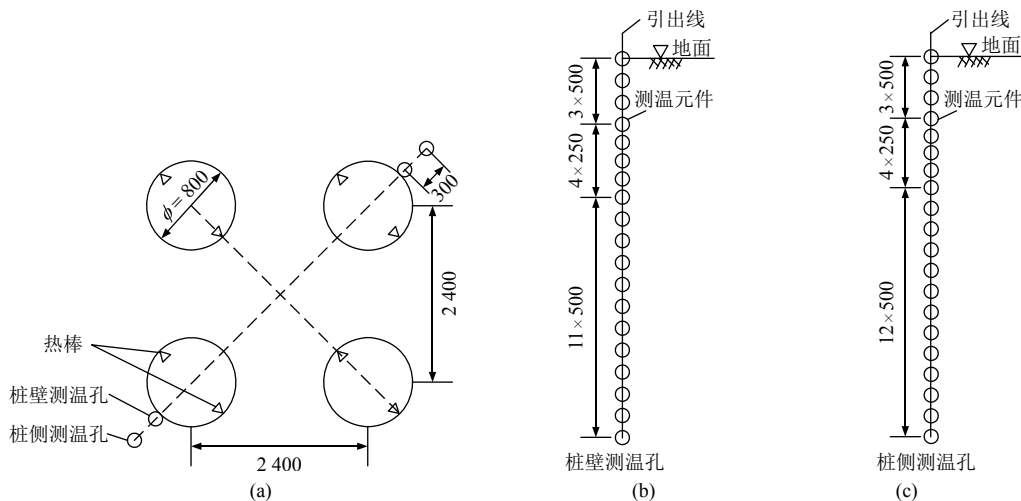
电力杆塔热棒桩基平面图及测温元件布置图(单位: mm)
